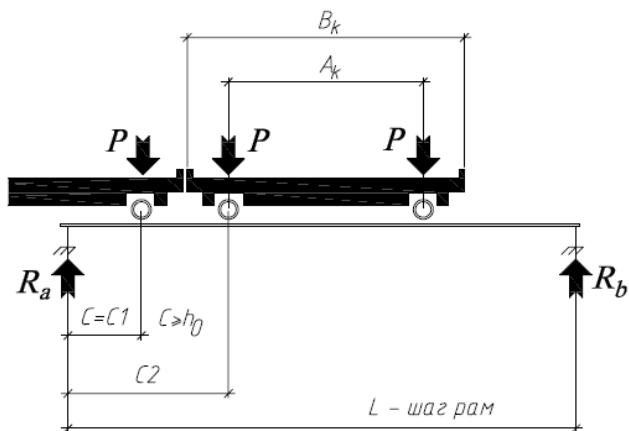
а Неблагоприятное расположение кранов для наклонного сечения подкрановой балки с пролетом 12 м.
